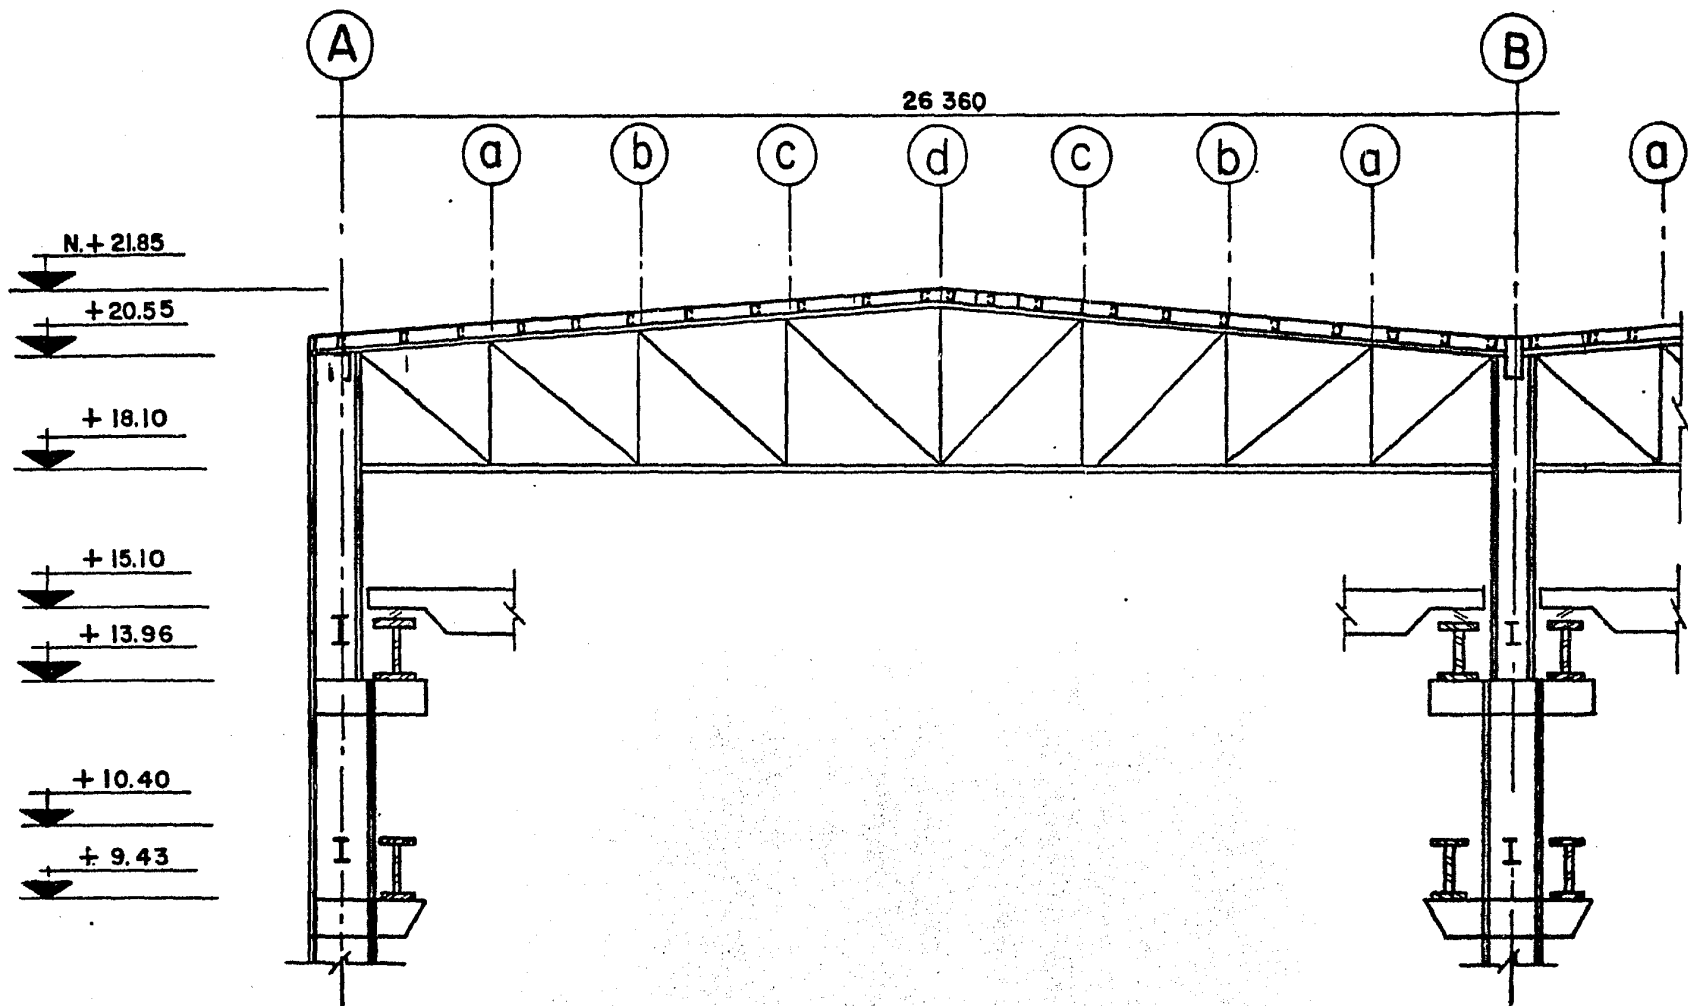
ARMADURAS PRINCIPALES Y TRABES CARRIL
